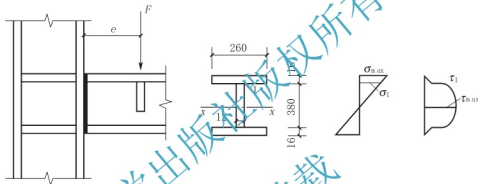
工字形截面牛腿与钢柱连接的对接焊缝
